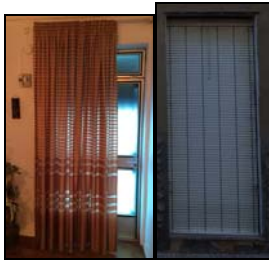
Puerta de acero principal de la vivienda. Fuente propia.
